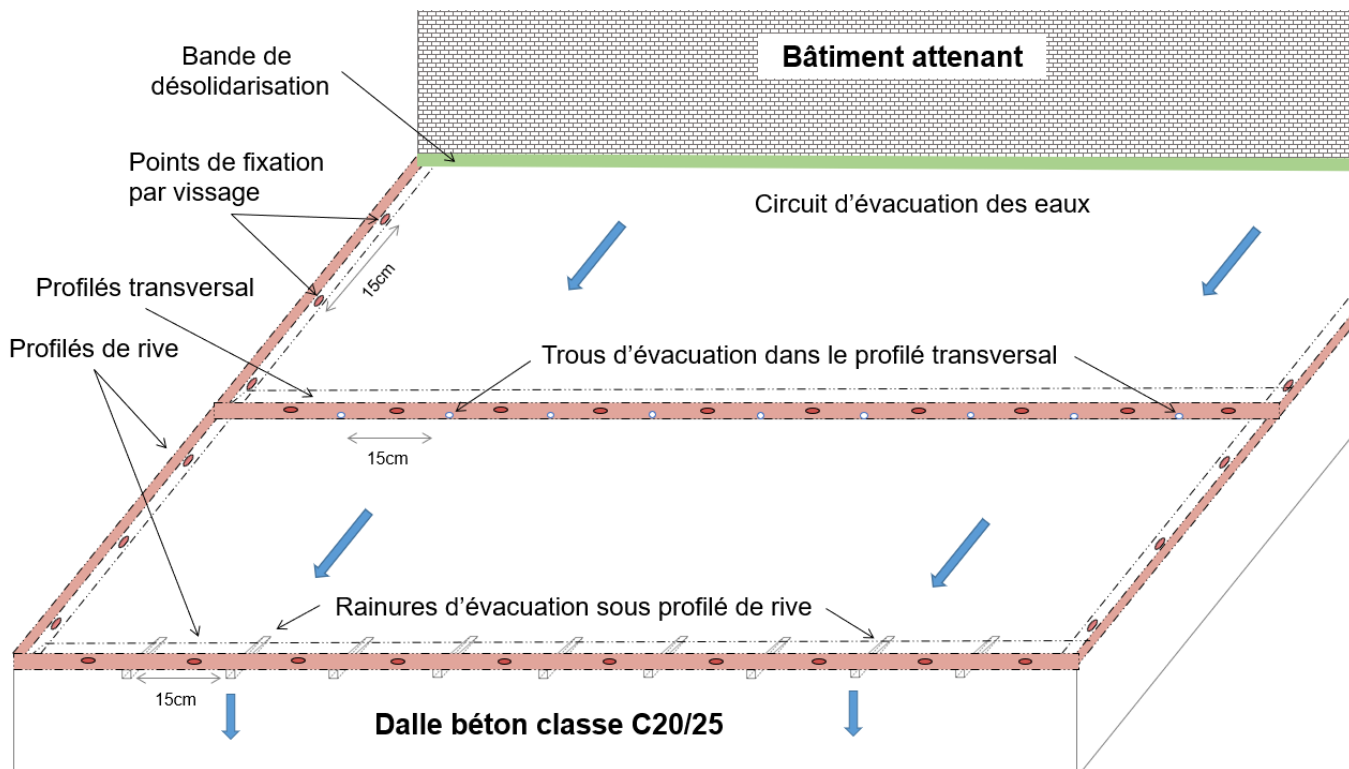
Schéma global d'une terrasse en béton avec son dispositif d'évacuation des eaux
